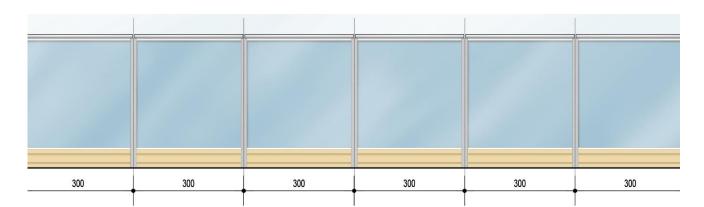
BARRIERA ACUSTICA FONOISOLANTE TRASPARENTE-PROSPETTO LATO SORGENTE
